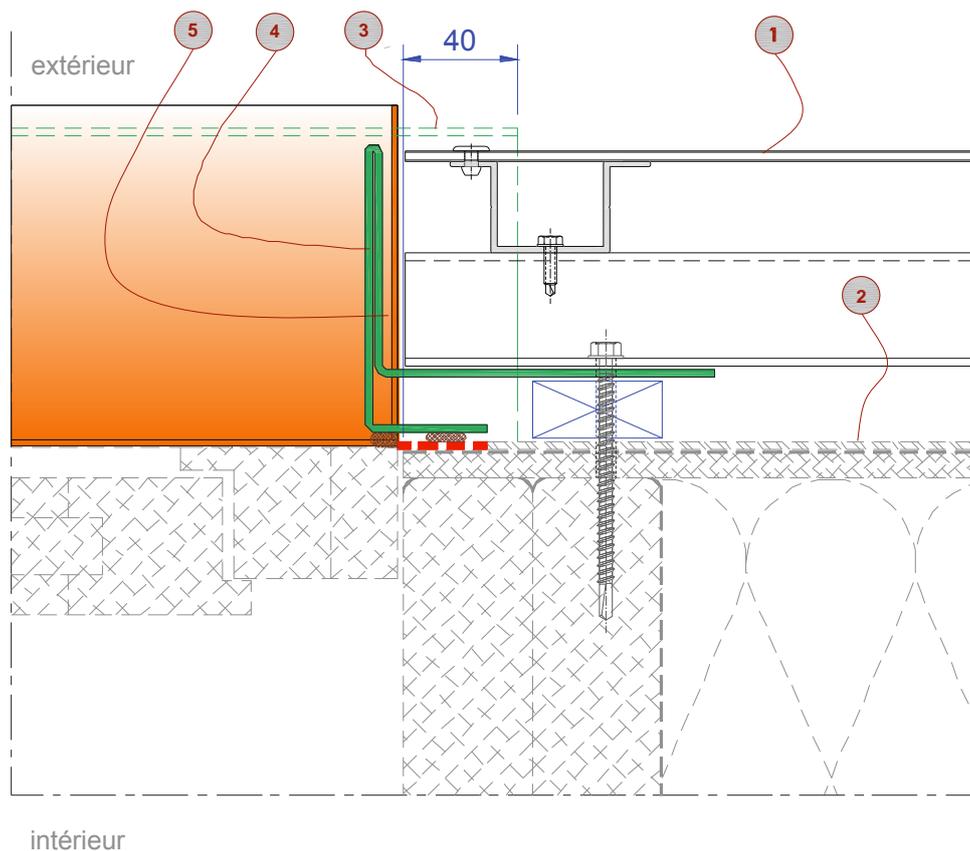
Pose sur COB - Coupe sur linteau de baie
